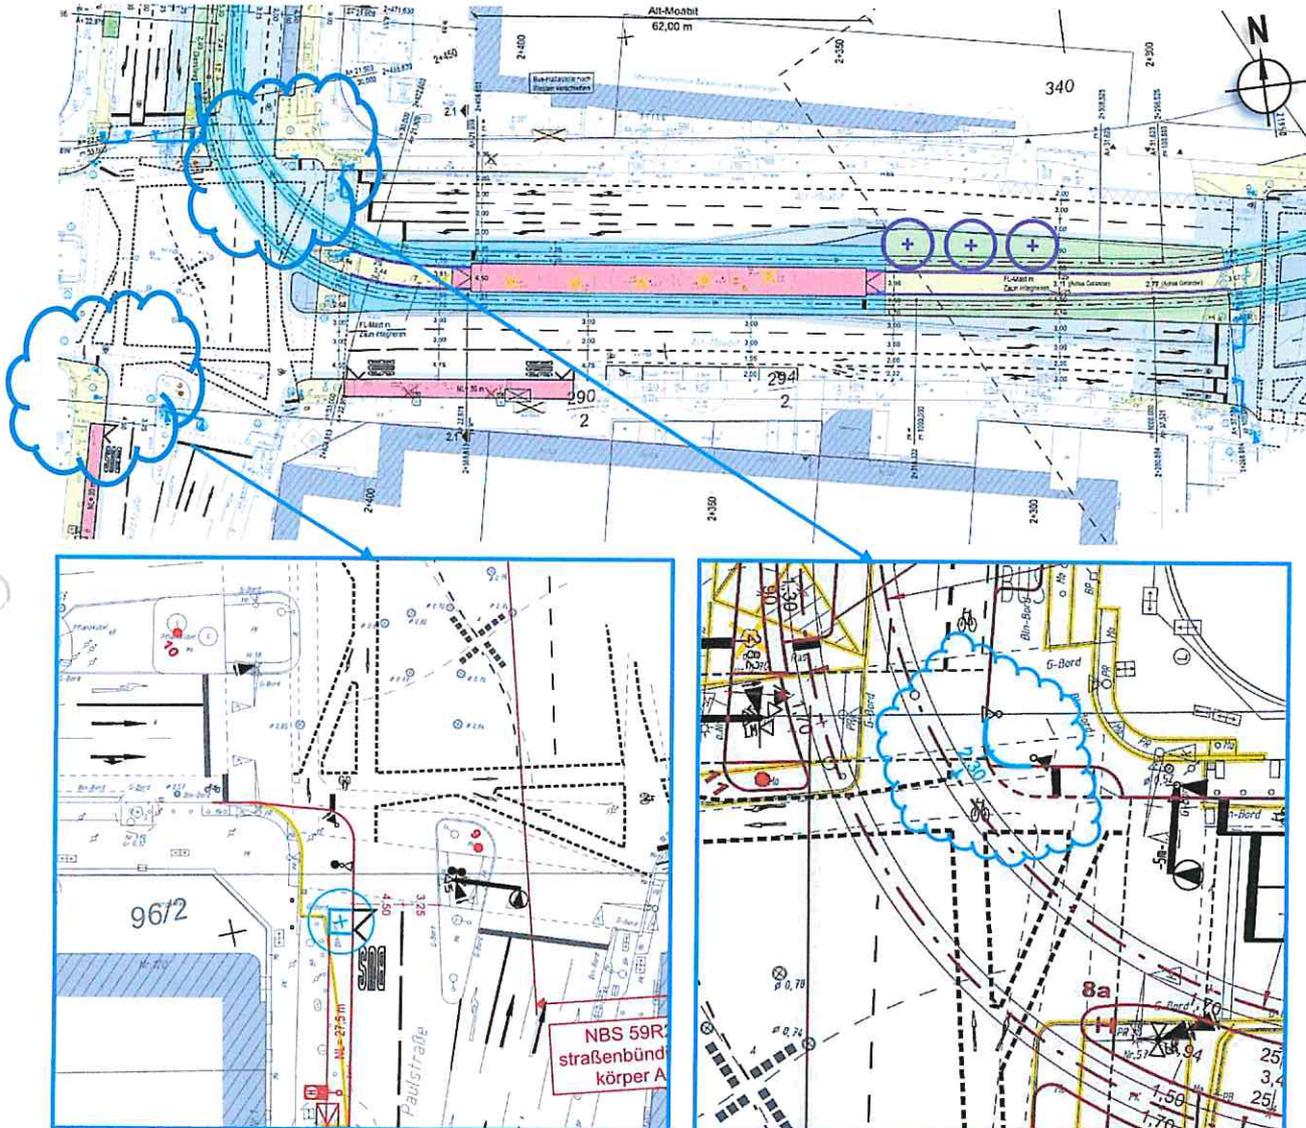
Lageplan Alt-Moabit mit zusätzlichem Baumstandort Paulstr. u. Änderung Bordausrundung Rathenower Str. und drei zusätzlich geplanten Bäumen (östl. der Straßenbahnhaltestelle)
